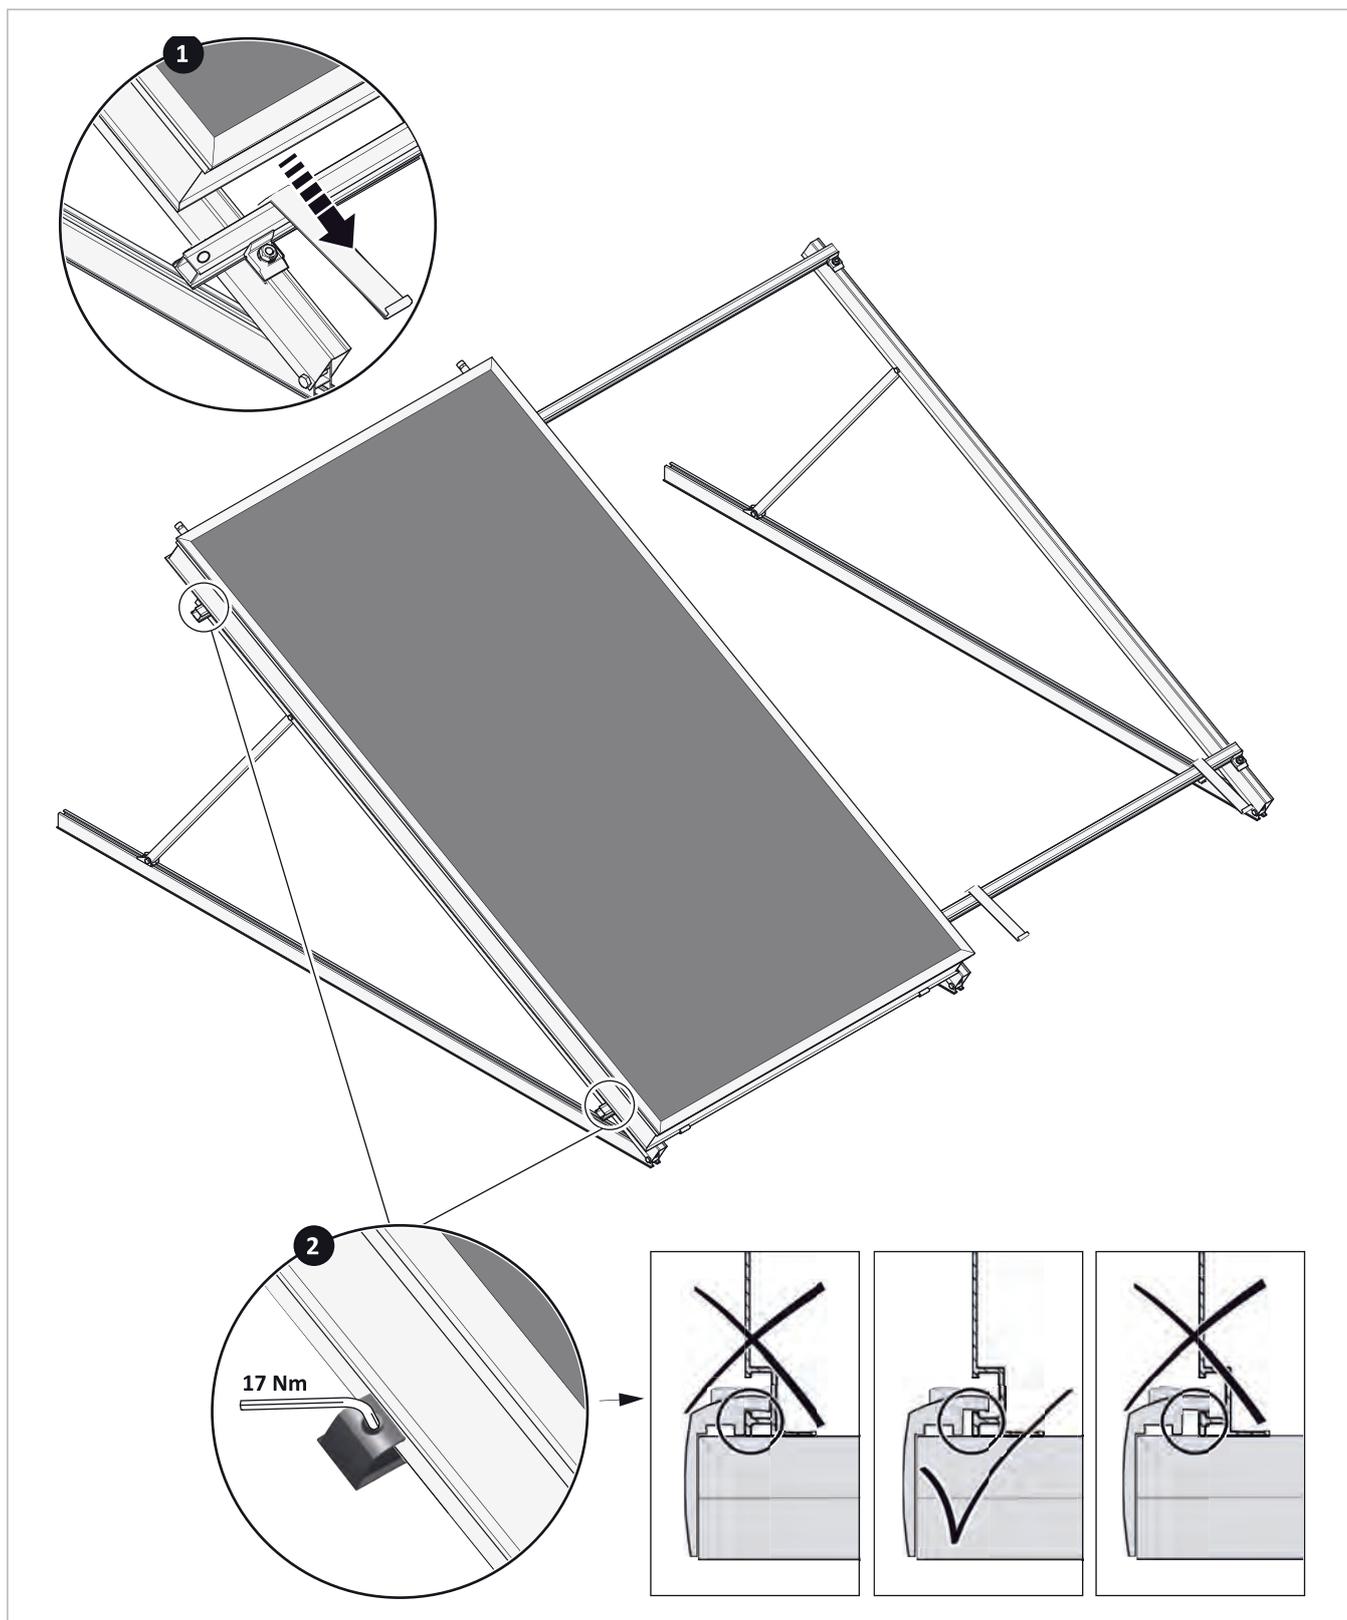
fissaggio di un collettore ai supporti per tetto piano
